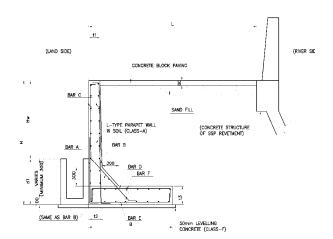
洪水防御壁Ⅳ型および直壁 標準断面図
